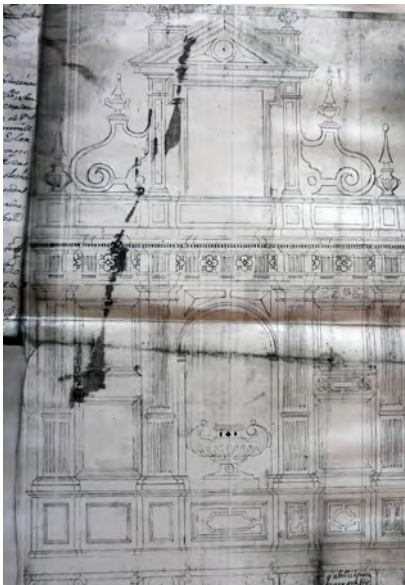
Planta y alzado del retablo de San Isidro, por Manuel de Prada.
